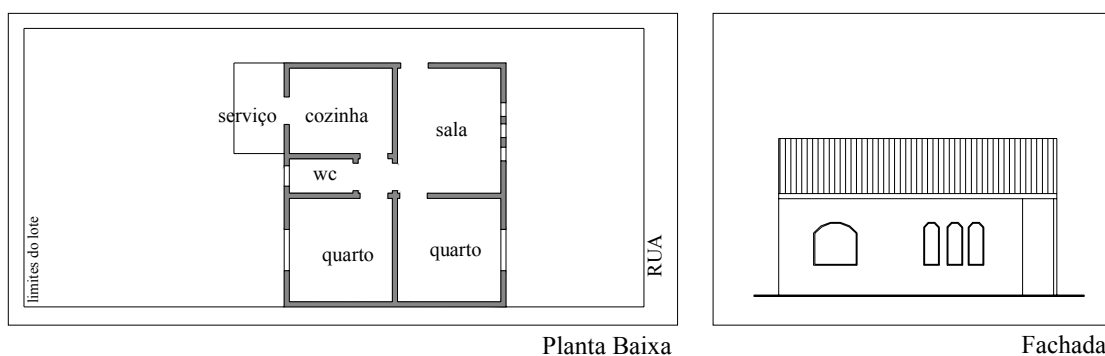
Projeto de casa predominantemente desejado pelos autoconstrutores.
